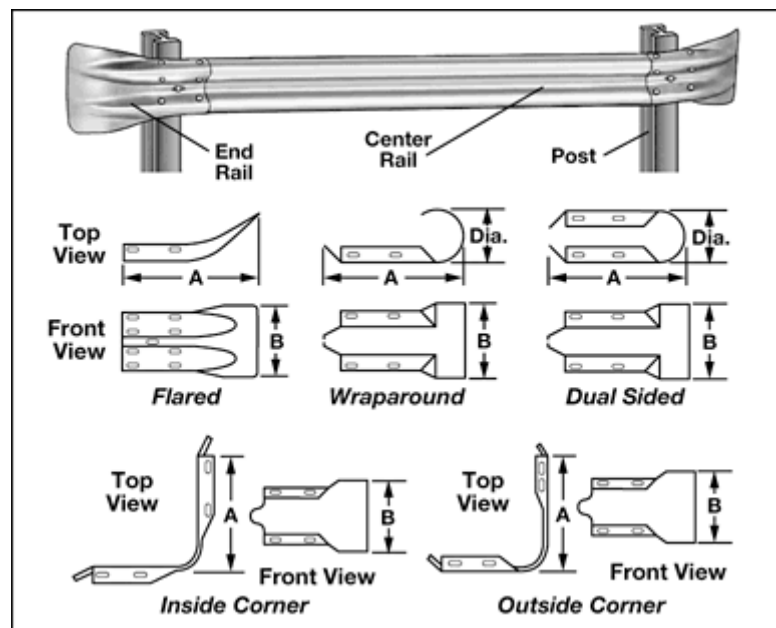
Detalhes de um guard rail (foto ilustrativa).
